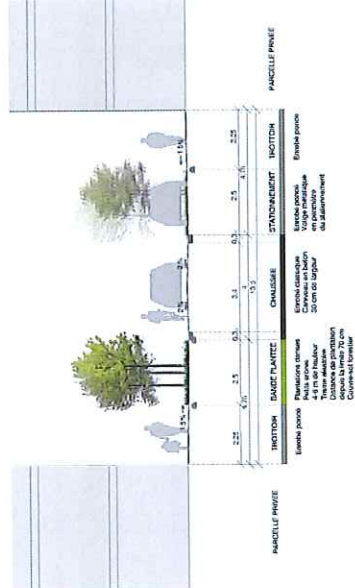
Profil type de la rue de la Reine Bathilde (voie circulée).
